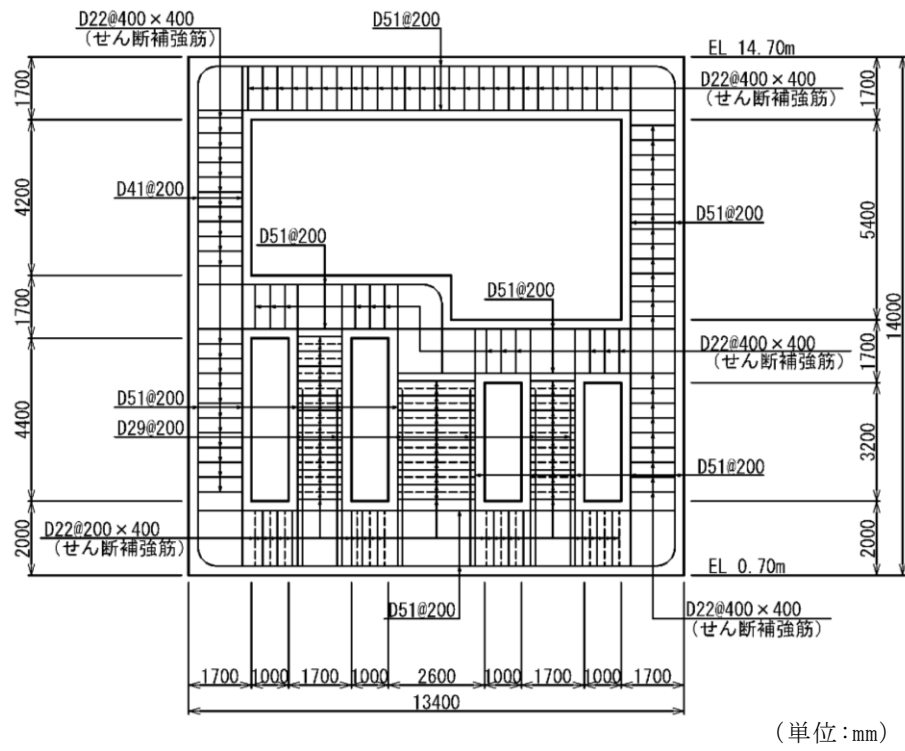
第 1 ベントフィルタ格納槽概略配筋図 (B-B 断面)
